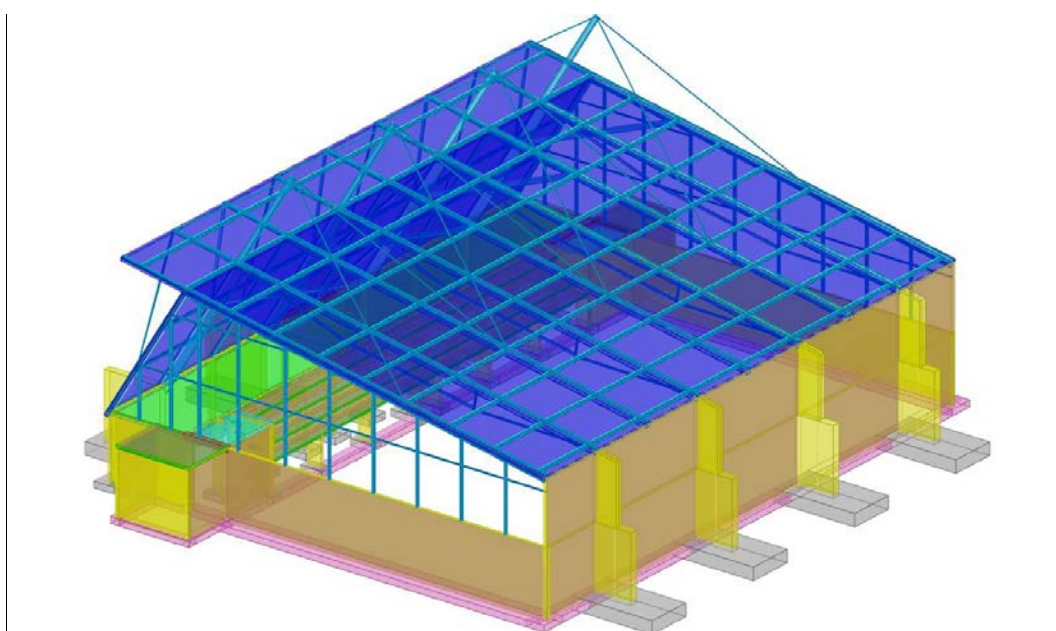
vista del modello FEM (caratteristiche geometriche)
